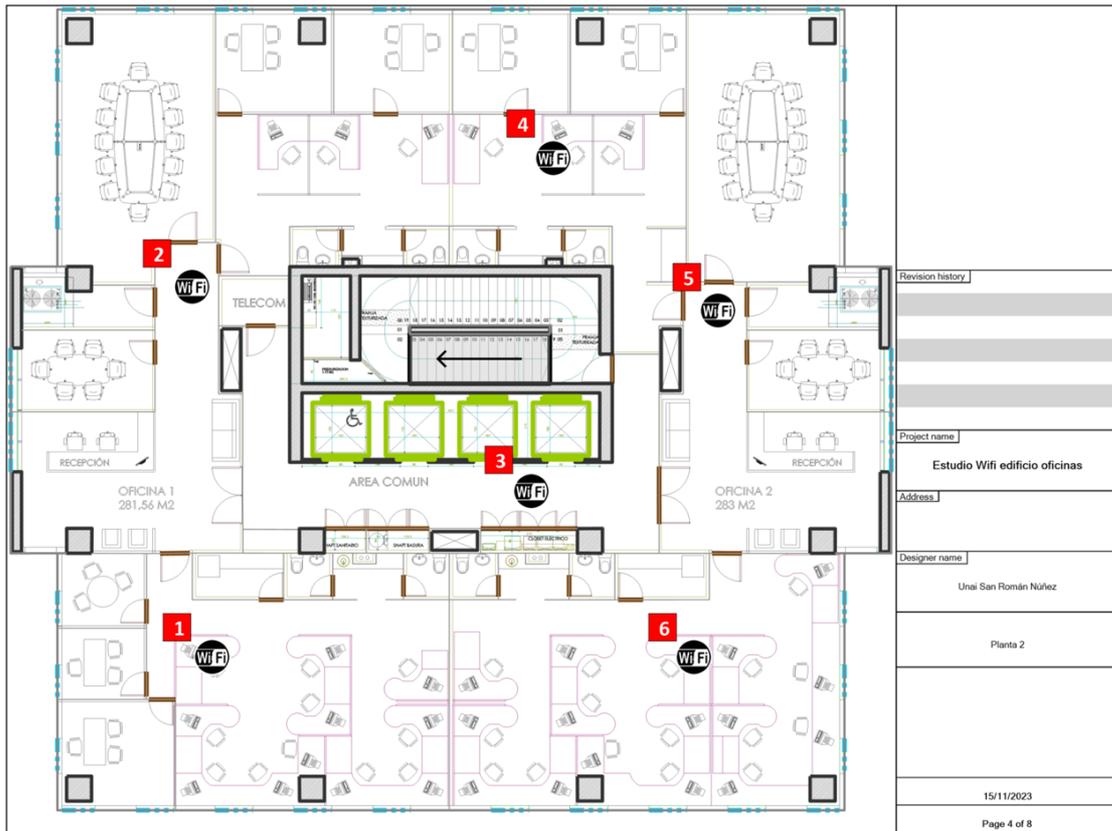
Posicionamiento Puntos de Acceso. Planta 2.
